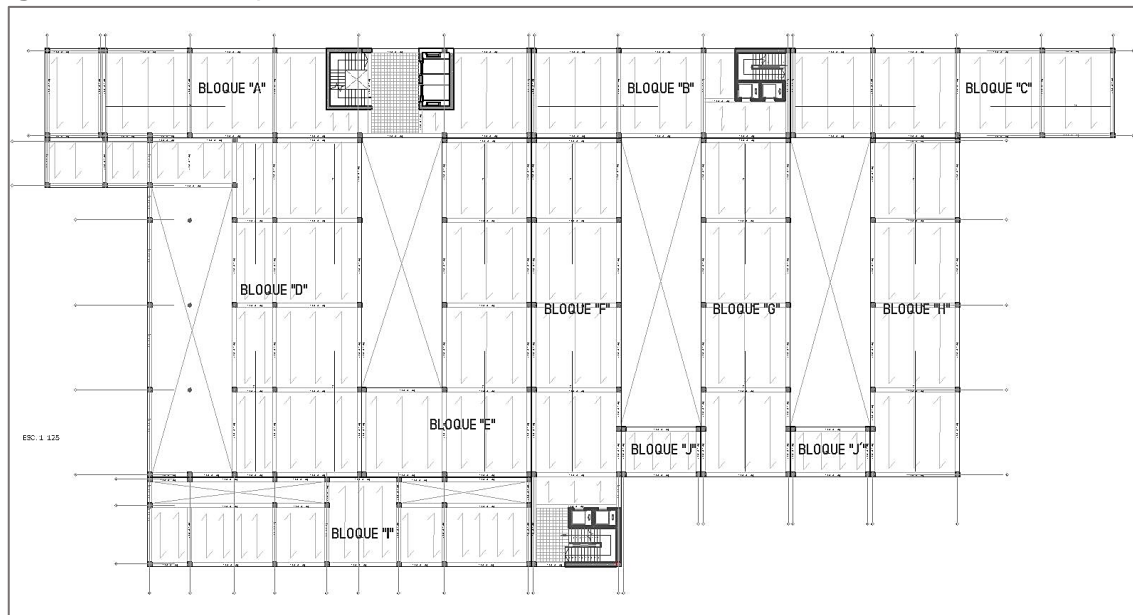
“Planteamiento general. Elementos estructurales.”
